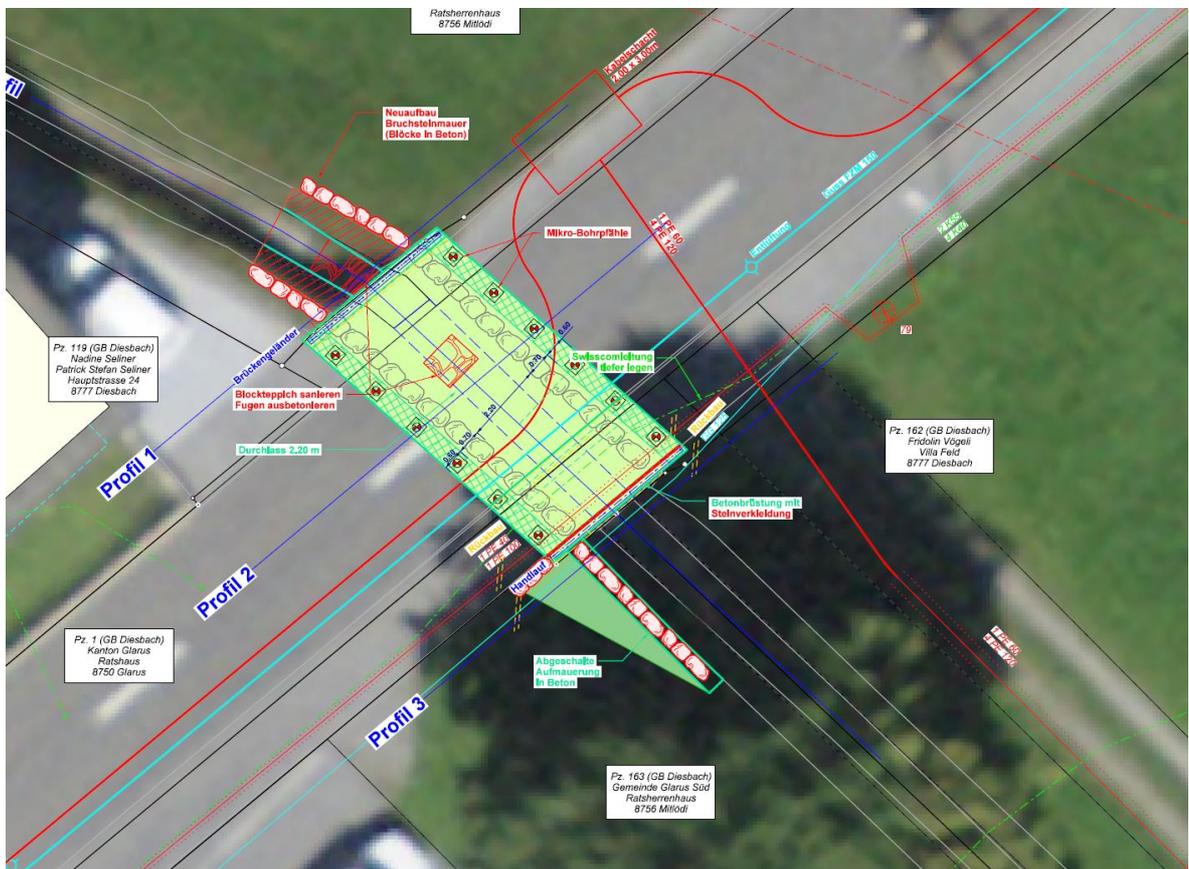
Situation Sanierung Verbauungen Dollrunse und Kantonsstrassen-Durchlass (Ausschnitt aus Plan-Nr. 1278-002)
